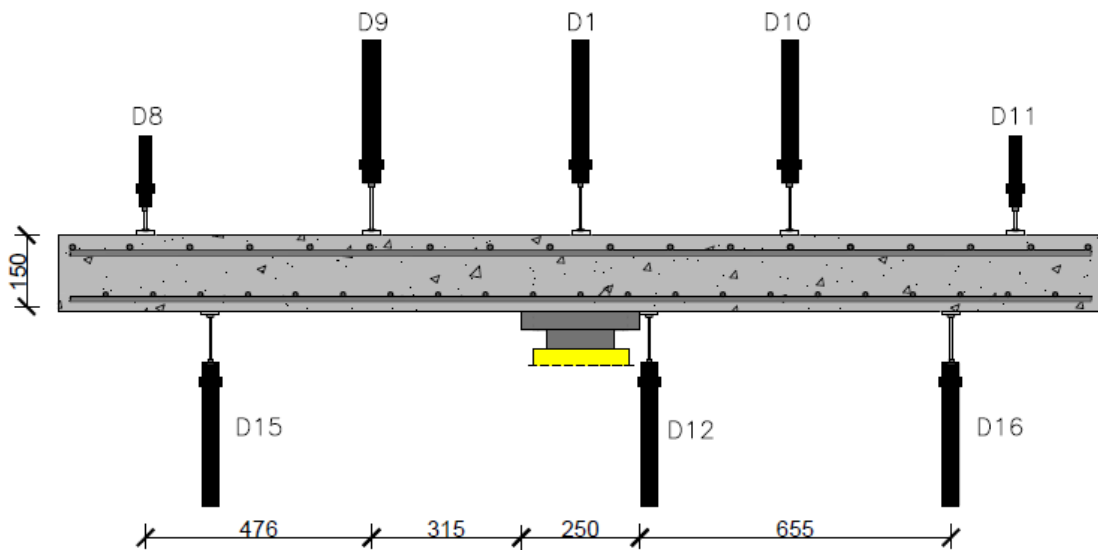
Disposição em planta dos defletómetros sobre a superfície superior do modelo de laje (desenho sem escala e dimensões em mm)
